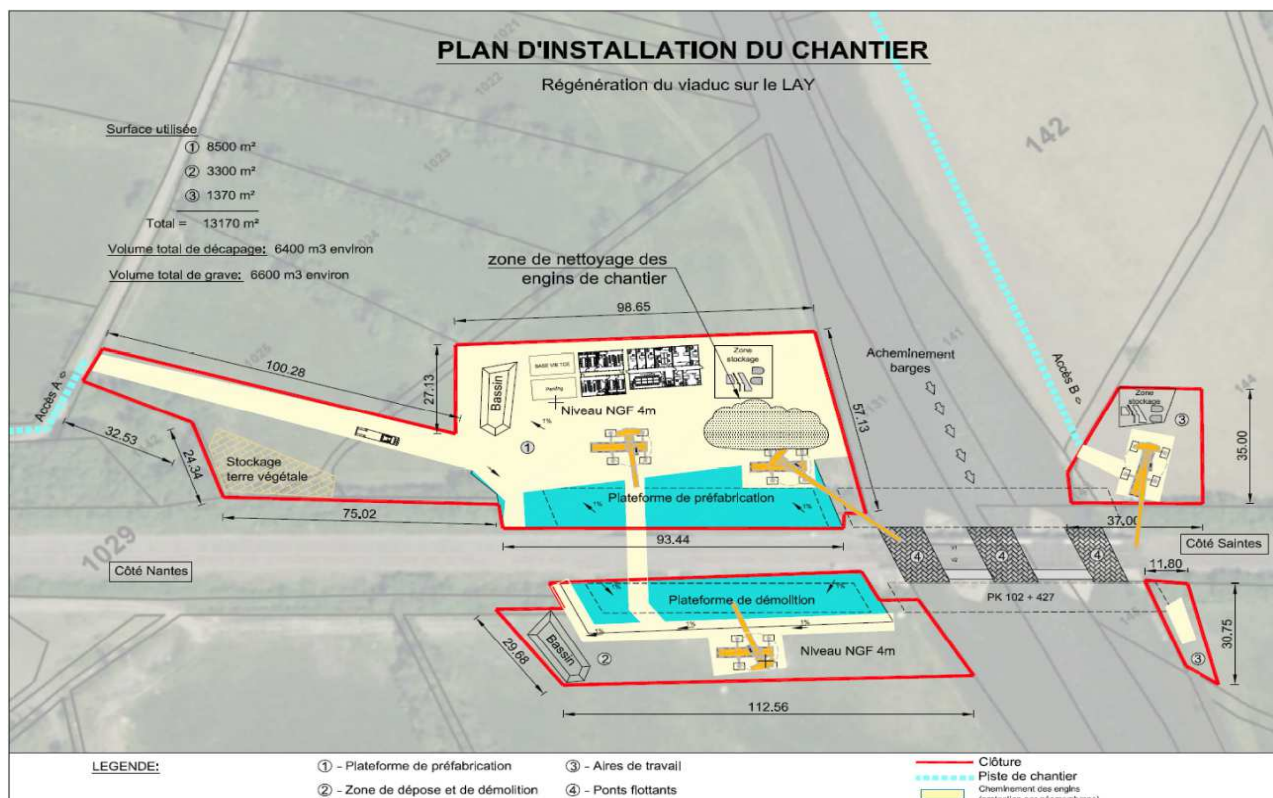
plan d'installation du chantier (source : dossier d'enquête publique p. 18)
